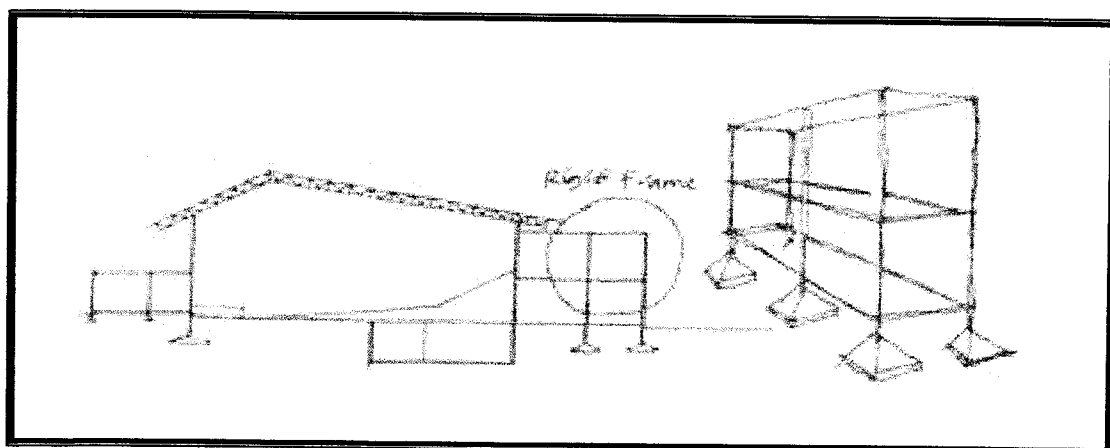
Konsep Struktural Ruang Pagelaran Wayang
